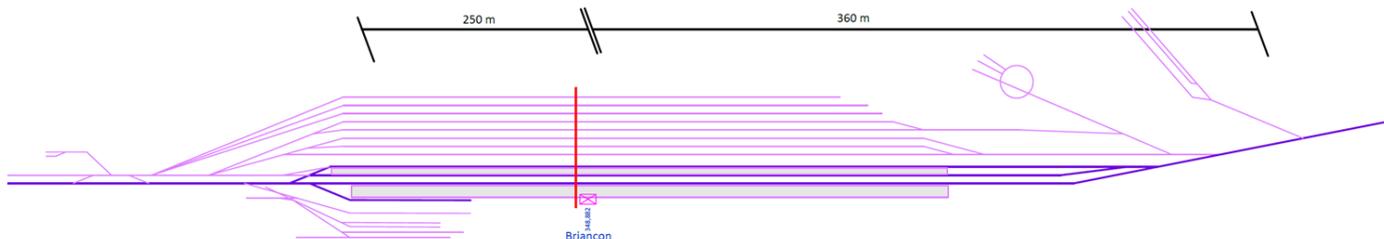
Configuration actuelle du plan de voie (ARCADIS)
